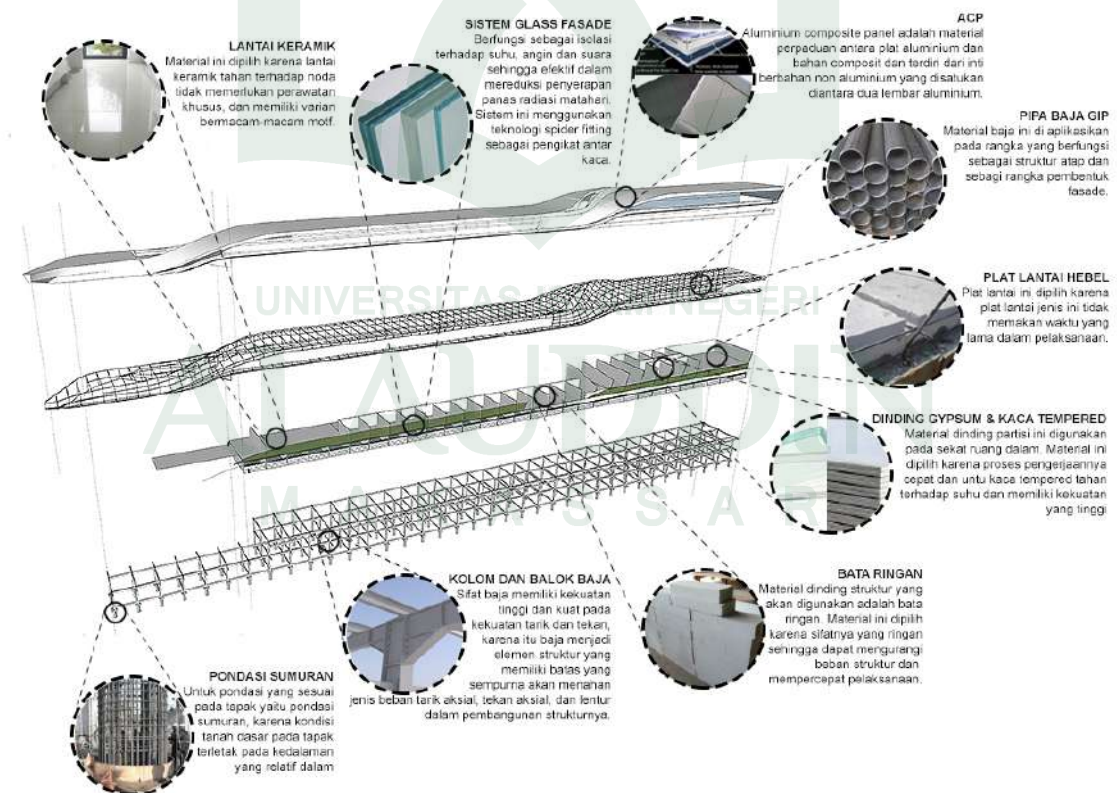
Konsep Bentuk Bangunan Pit Garasi
